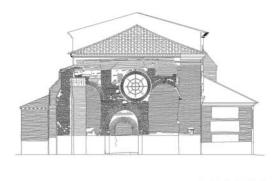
Alzado de la fachada a poniente del templo, estado actual
